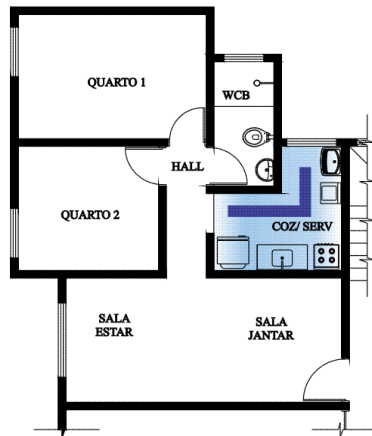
Planta Baixa Pav. Tipo do Residencial Germano Santos (sem escala)
